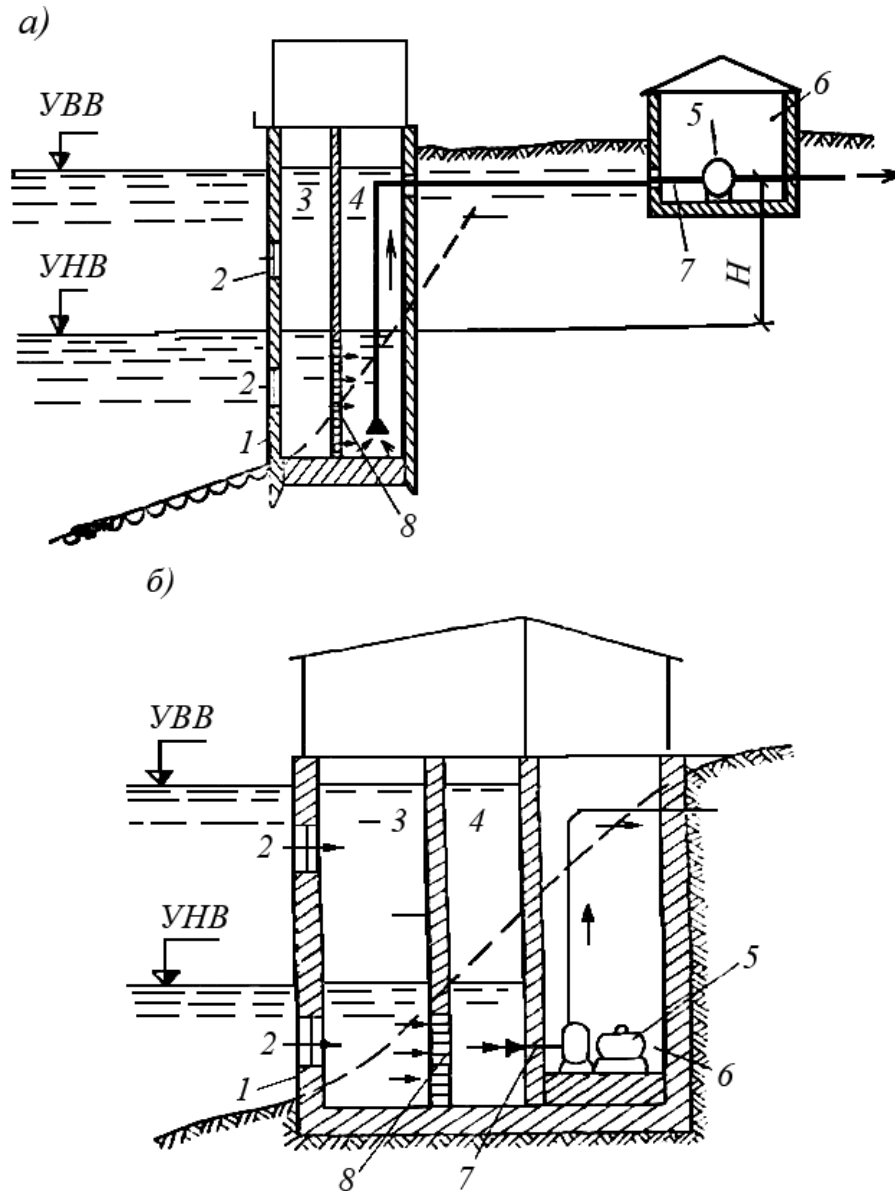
Водоприемники берегового типа: *а* – раздельный; *б* – совмещенный; 1 – водоприемный колодец; 2 – входные окна; 3 – приемная камера; 4 – всасывающая камера; 5 – насосы; 6 – машинный зал; 7 – всасывающие трубопроводы; 8 – сетки
